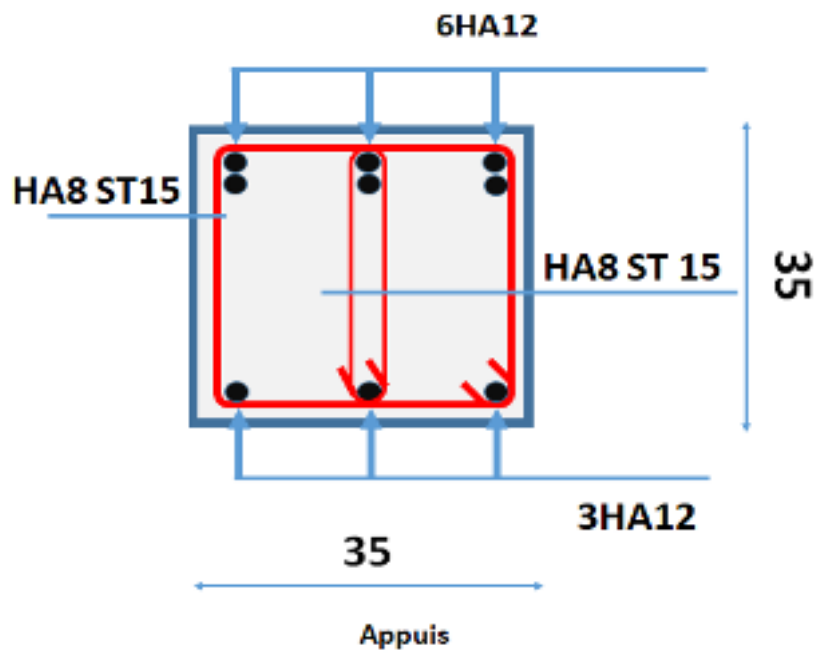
Schéma de ferrailage des poutres secondaires.
